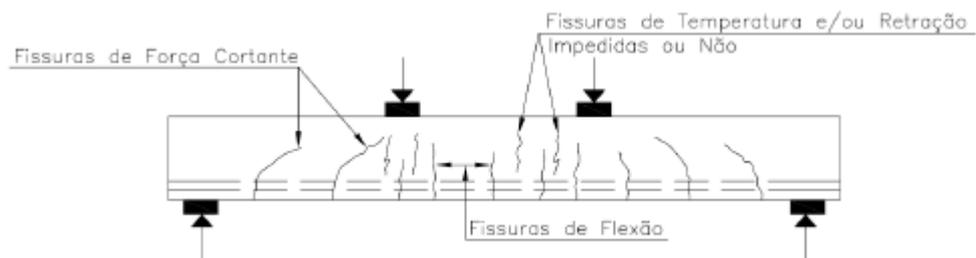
Fissura de Retração na Alma da Viga.
